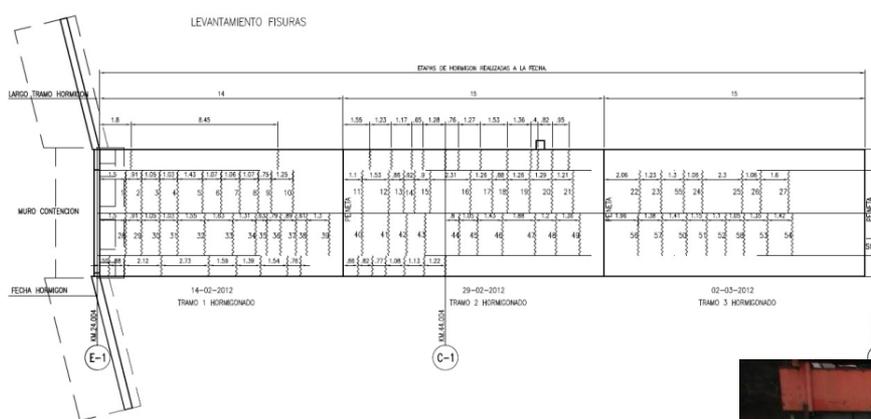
levantamiento de fisuras / grietas en obra.
